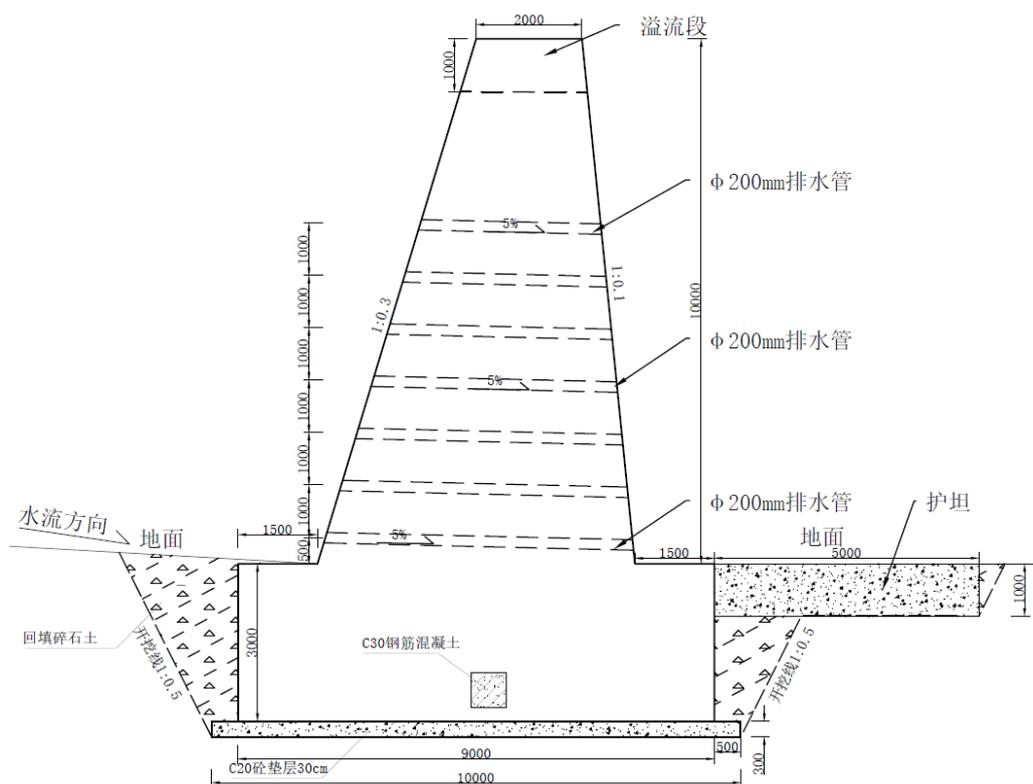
III 型拦挡坝断面图 (mm)
